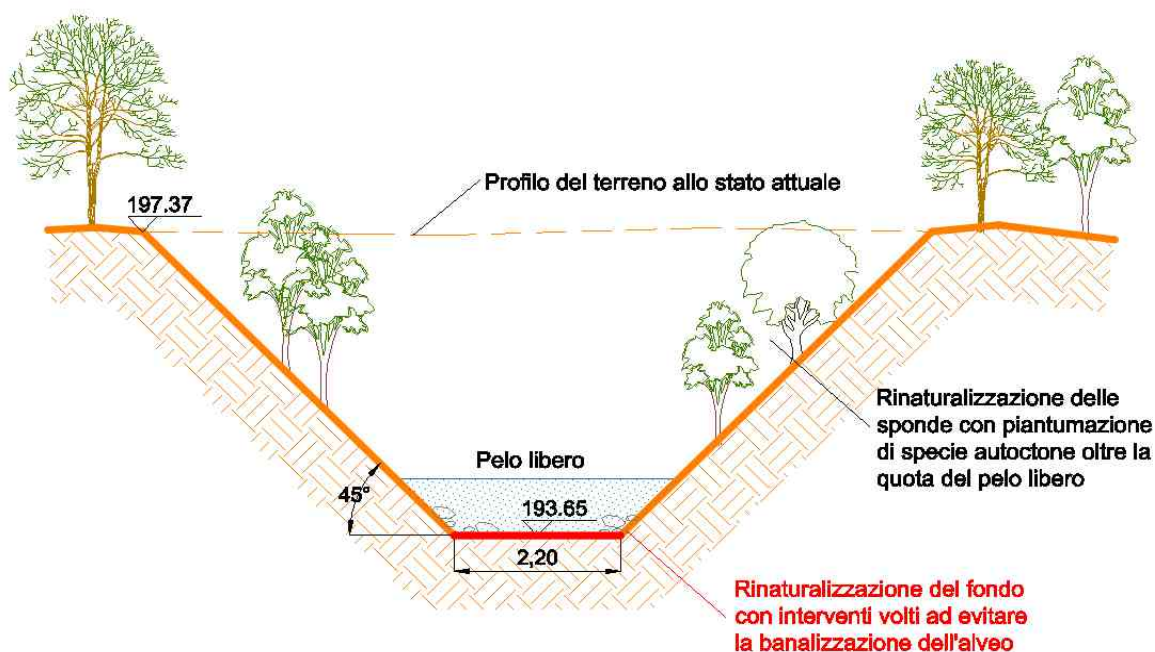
Sezione tipo del canale a cielo aperto, con fondo e sponde naturali.
